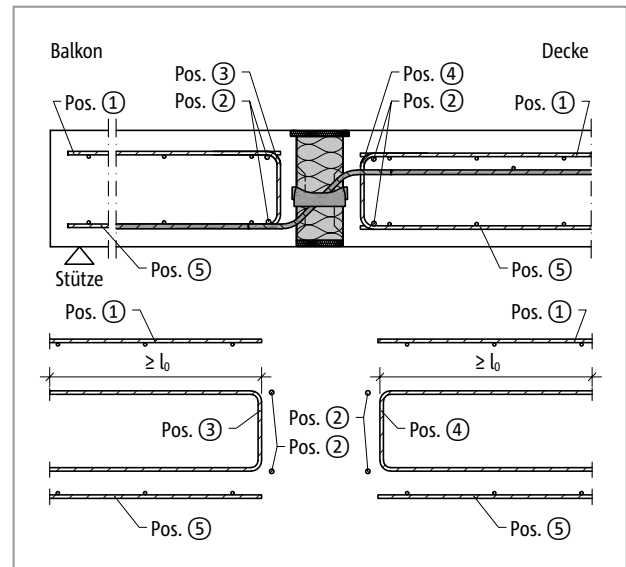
Schöck Isokorb® T Typ Q-V6 bis Q-V12: Bauseitige Bewehrung
